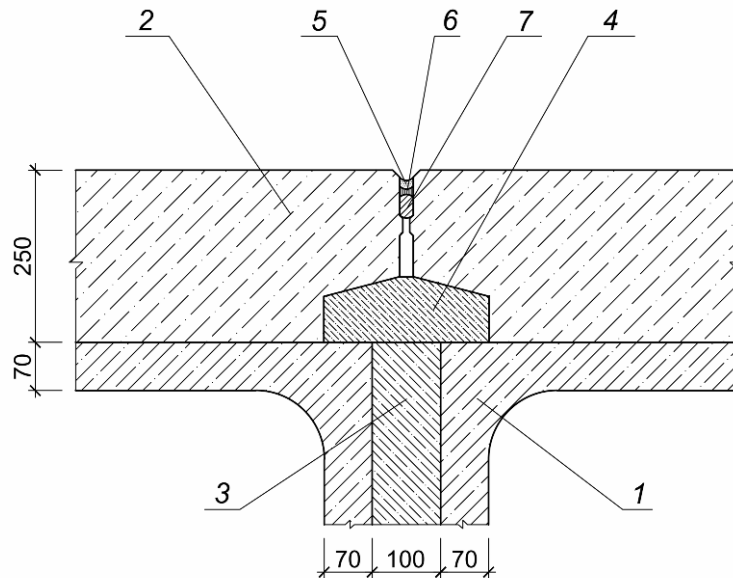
Схема проектного решения сопряжения внутренних и наружных стен (система дополнительного утепления наружных стен с вентилируемым фасадом не показана): 1 — железобетонная конструкция объемного блока; 2 — навесная панель из керамзитобетона; 3 — железобетонная шпонка; 4 — заделка межпанельного шва керамзитобетоном; 5 — защитное покрытие; 6 — герметизирующая мастика; 7 — уплотняющая прокладка
